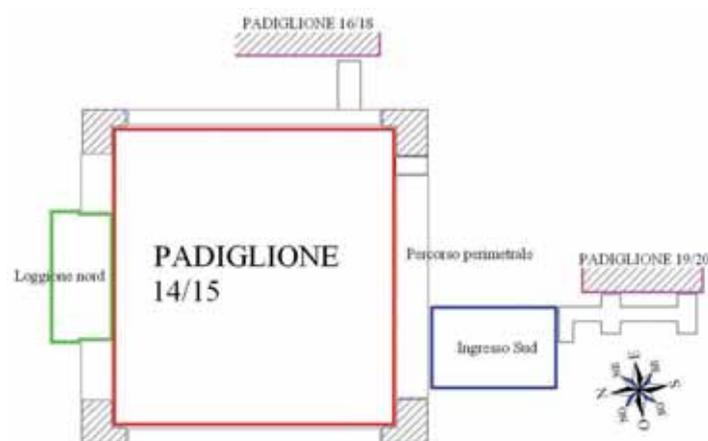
Schema distributivo in pianta del padiglione 14-15
